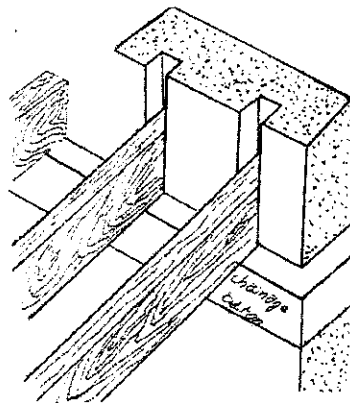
Encastrement des poutres en bois dans un mur en pisé
